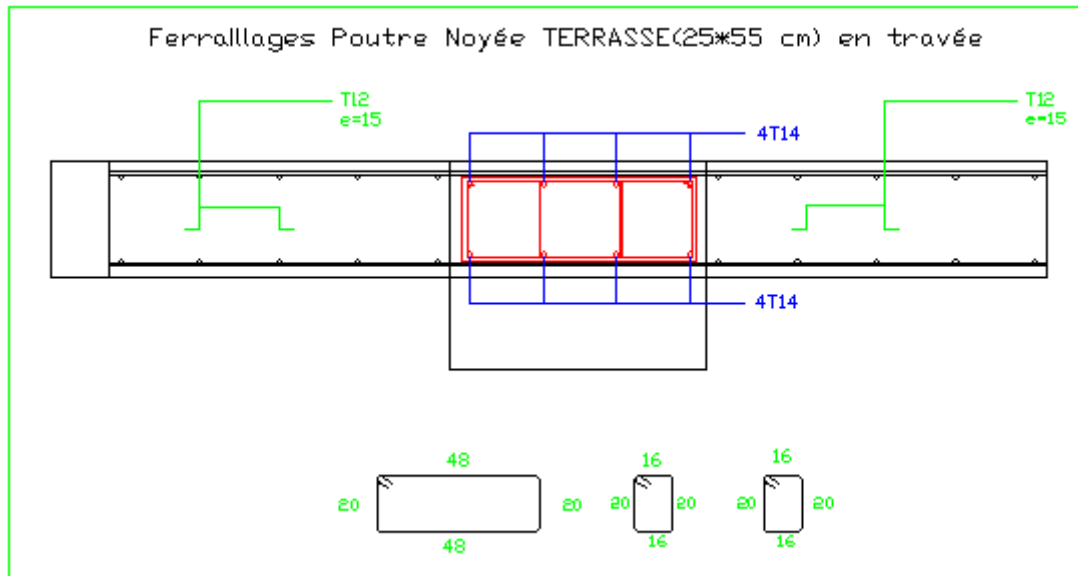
Ferrailage poutre noy  (25*55) appui et trav e terrasse
